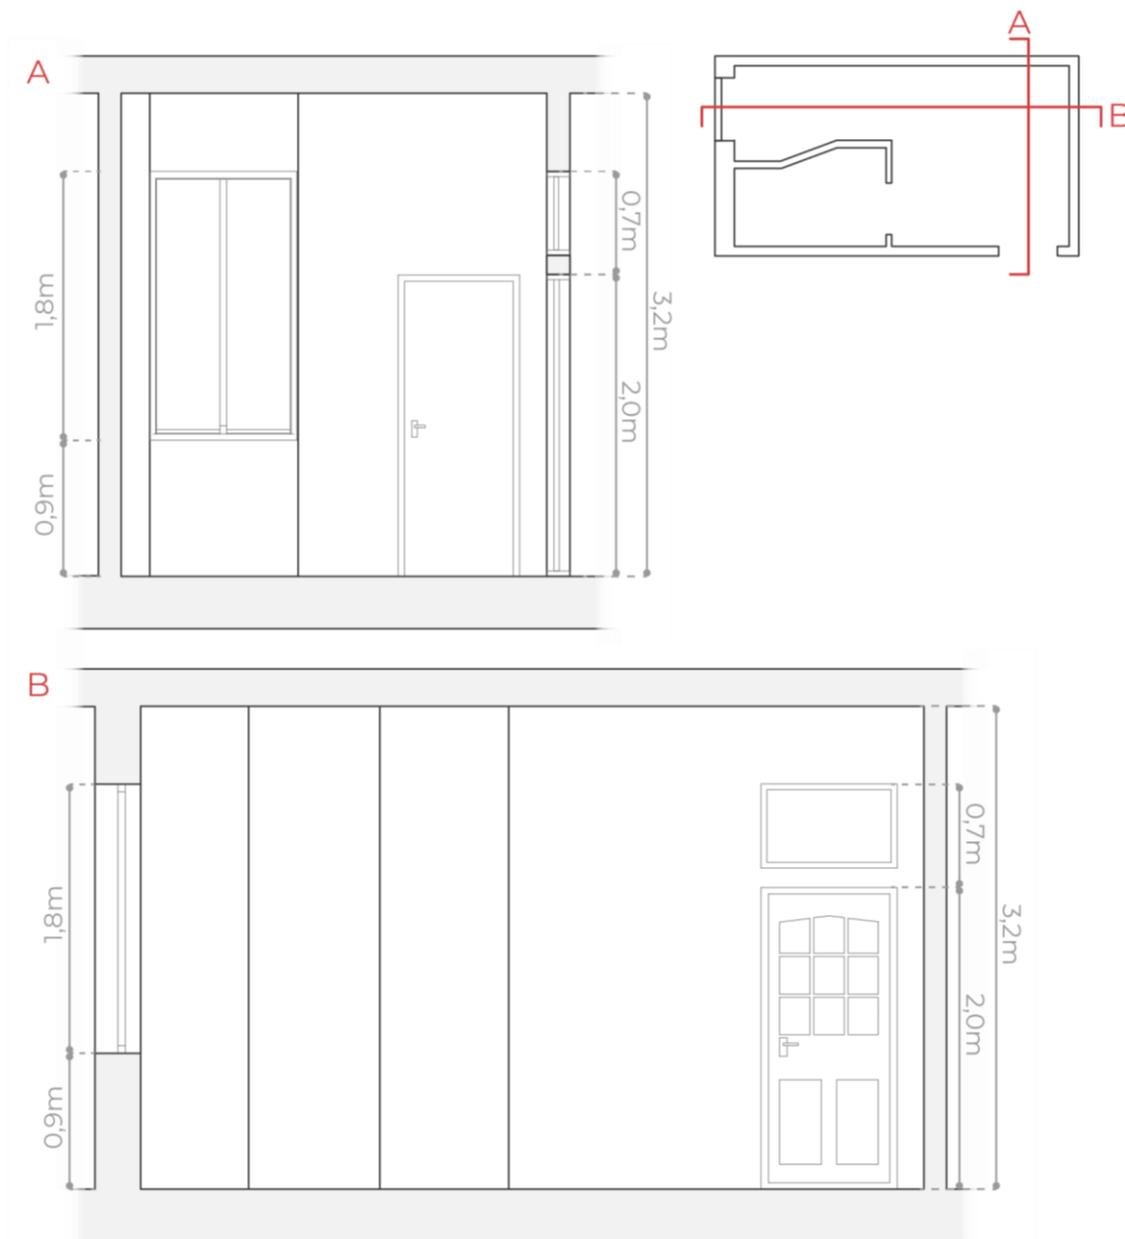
Secciones cotas caso de estudio. Escala 1:50. Fuente: elaboración propia.
